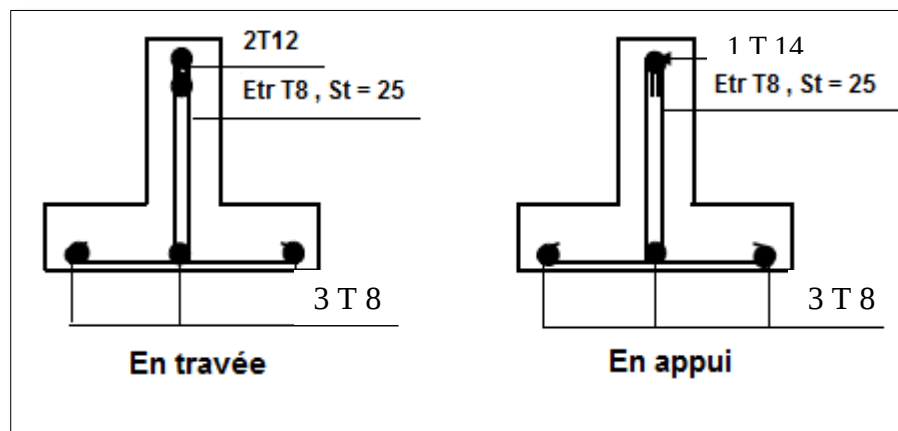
Schéma de Ferrailage de nervure (20+4).
